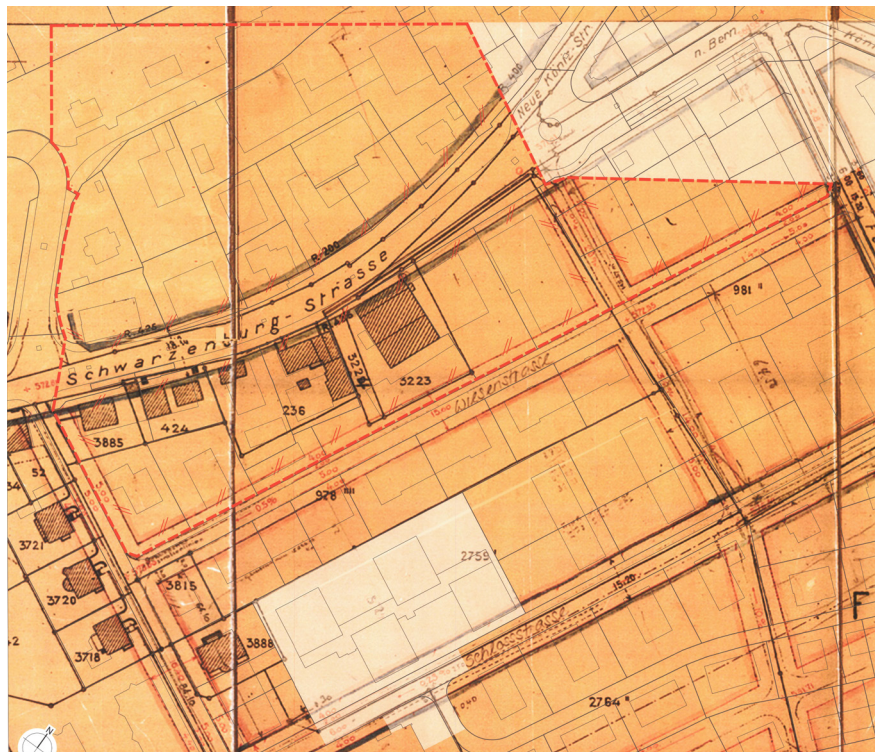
Auszug Allignementsplan Hauseinschlag - Wabersackerstrasse
